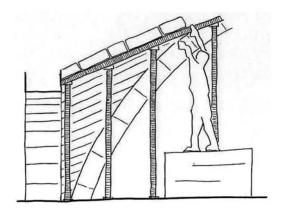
Hipótesis de construcción de la plementería de la bóveda de Zamora
